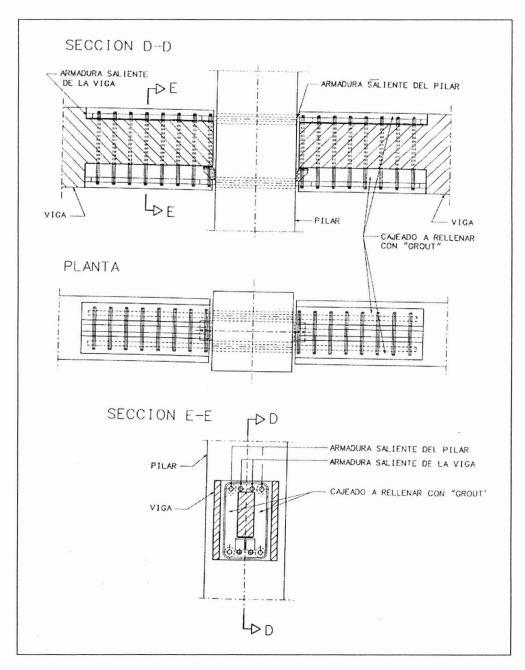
Nudo "pilar prefabricado-viga prefabricada" (con apoyo directo de montaje.).
